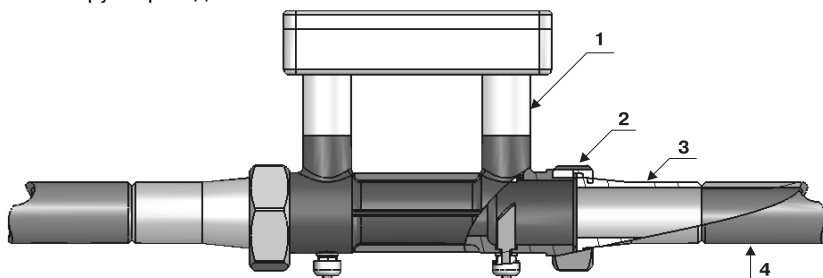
Схема установки расходомера с резьбовым соединением (Ду 20-32)
